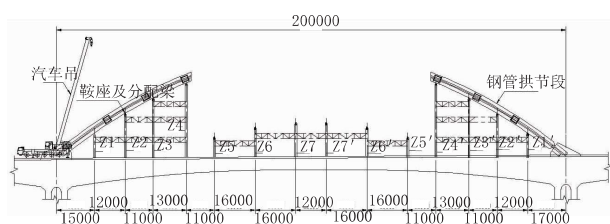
拱肋提升支架施工步骤一布置图(单位:mm)
